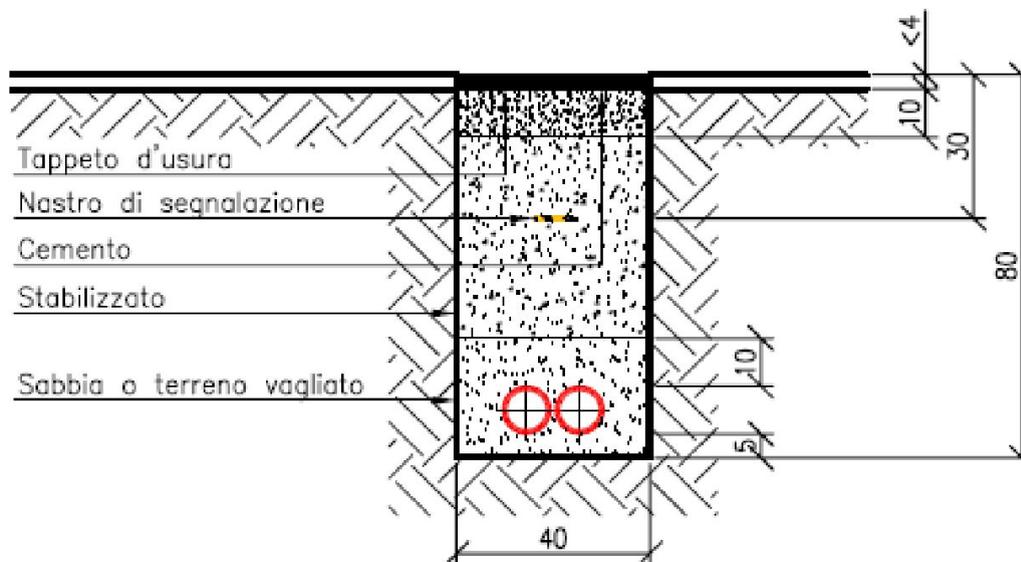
Figura B - Sezione tipo scavo tradizionale su marciapiede/pista ciclabile/area pedonale
